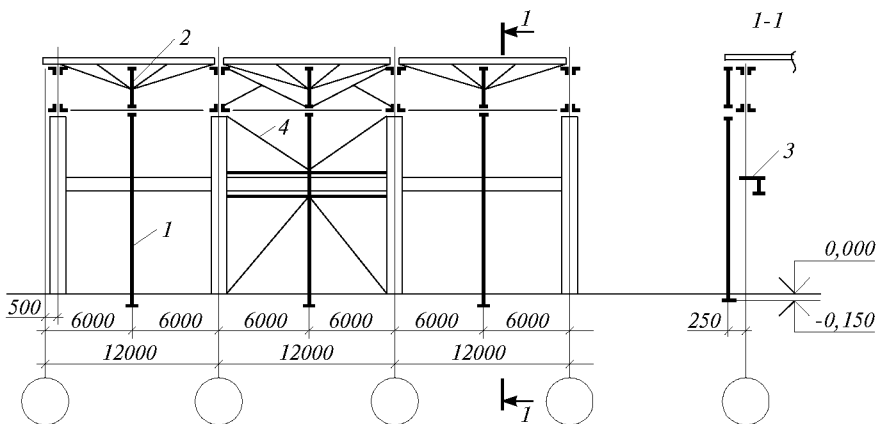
Продольный фахверк в здании с мостовыми кранами при шаге ферм 12 м
